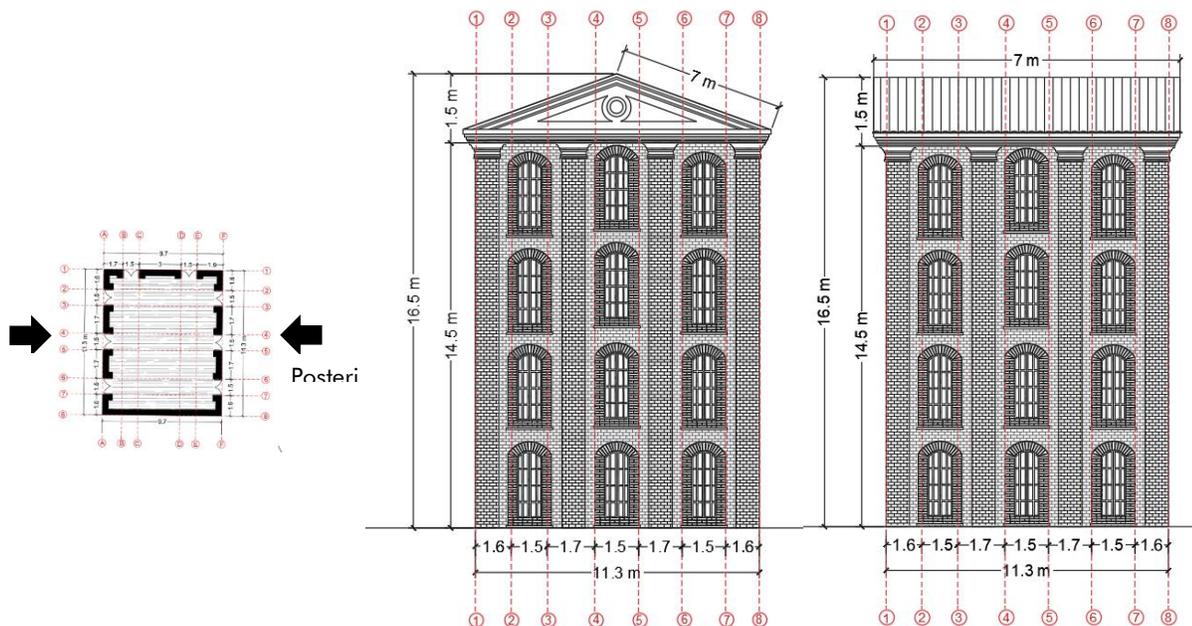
Planta unica del Edificio El Triunfo Fuente:
